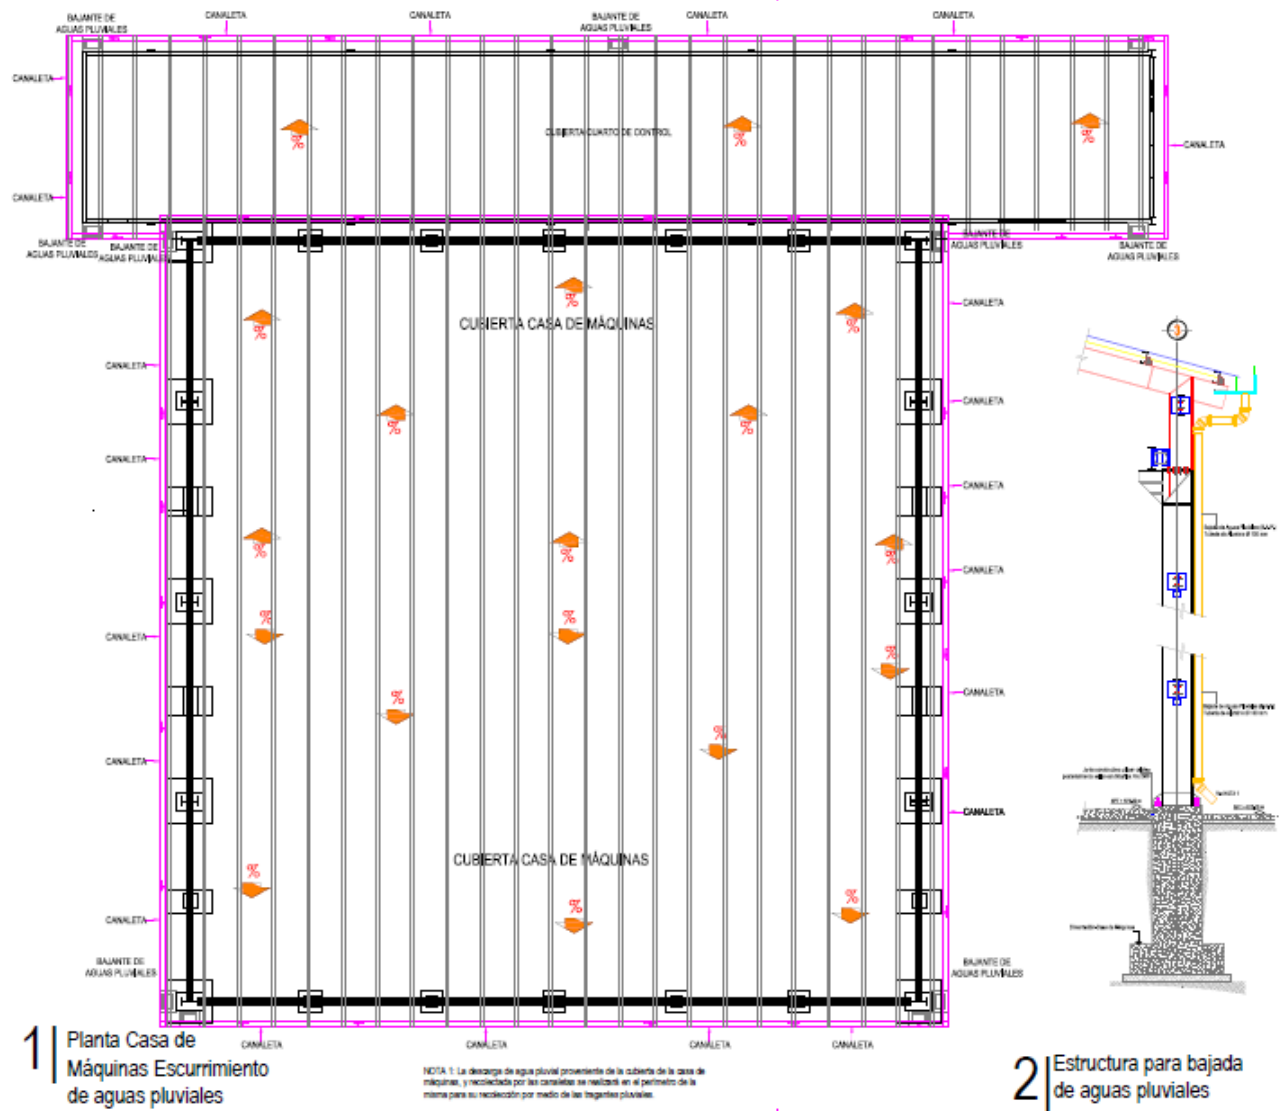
Drenaje pluvial en casa de máquinas y edificio eléctrico
